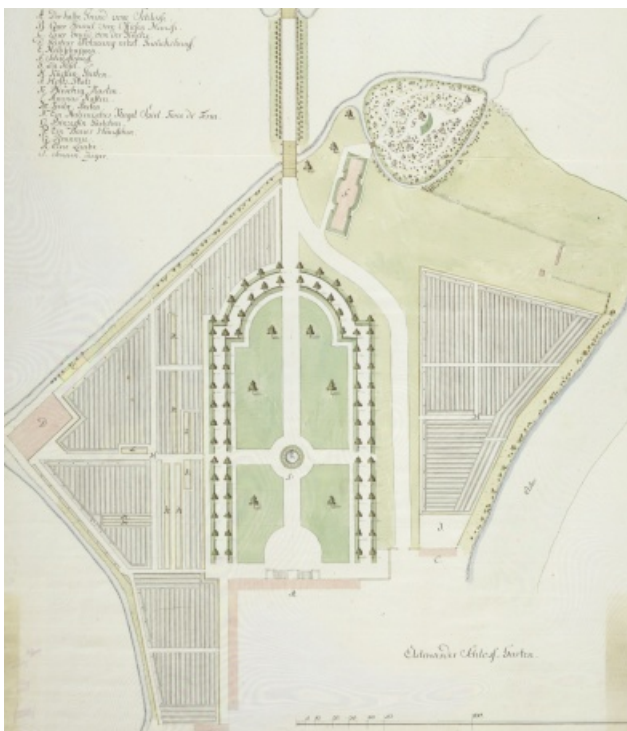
Lageplan Schloss und Garten Elsterwerda, um 1780
